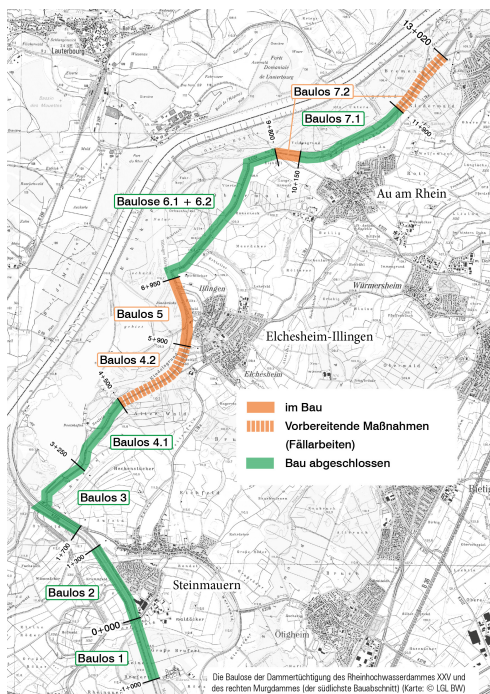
Lageplan Baufortschritt, Copyright LGL BW
